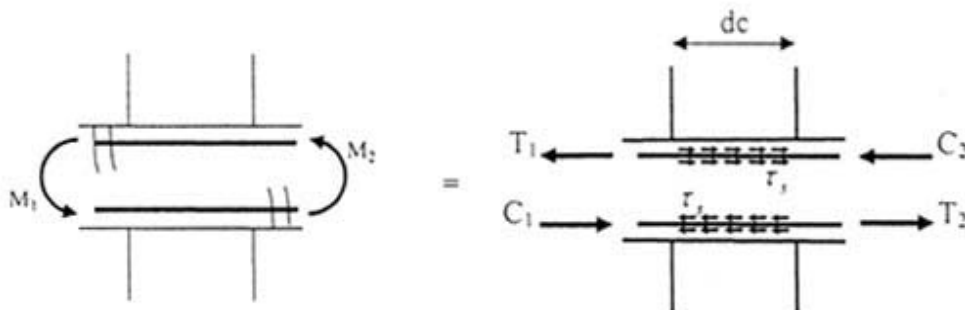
Momento máximo de adherencia y fuerzas internas en las barras de una junta interior viga plana-columna.
